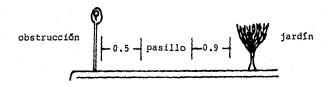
Situaciones donde se ilustran los anchos efectivos.
